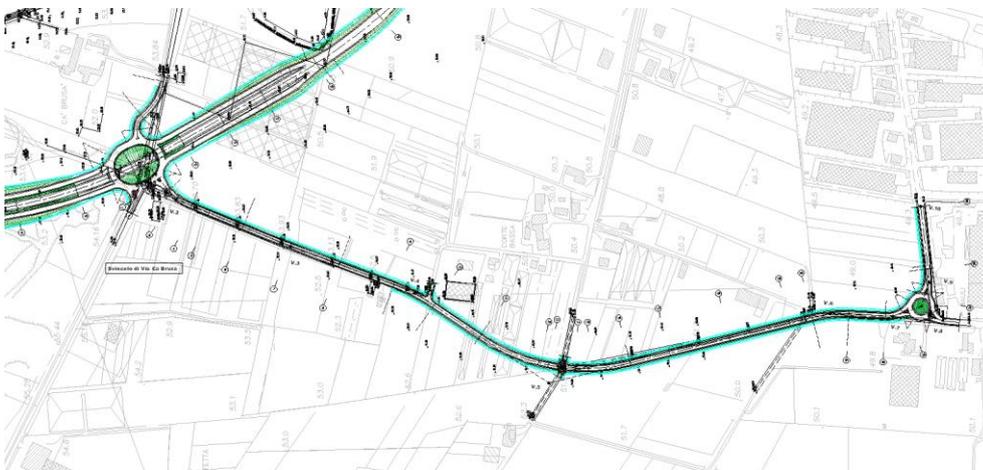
Collegamento Z.A.I. di Castel d'Azzano
